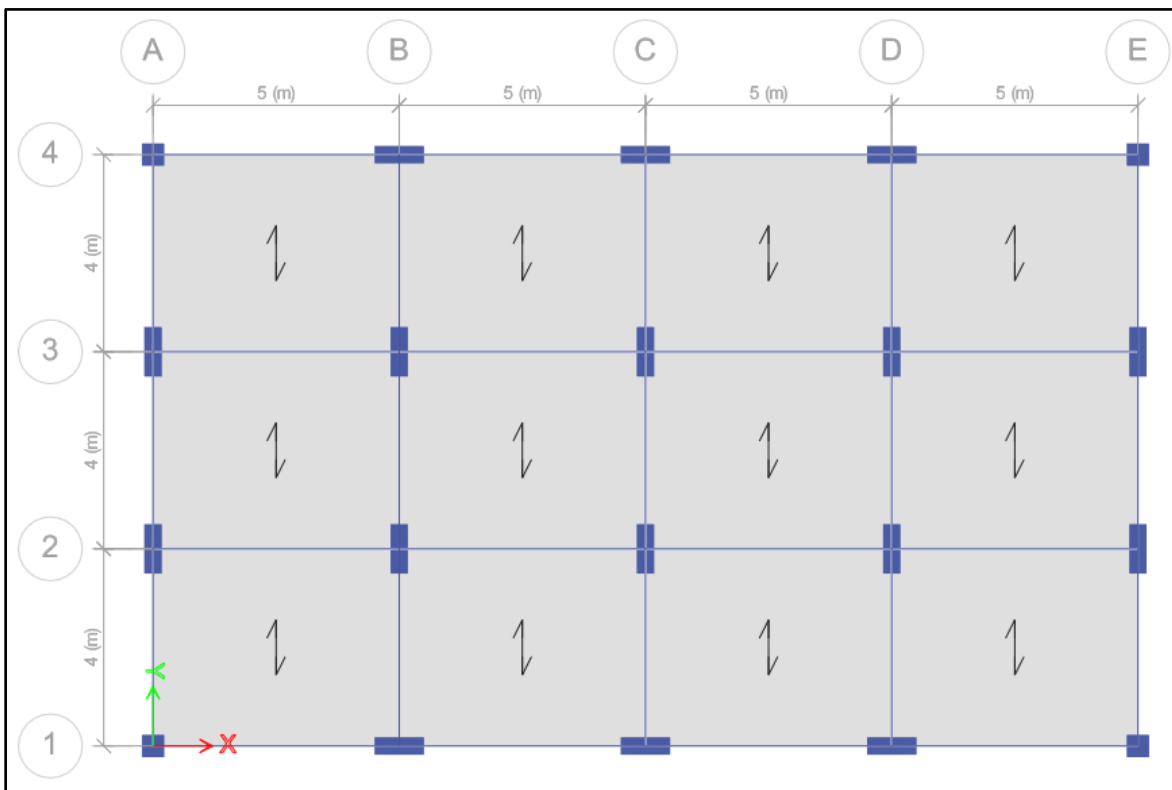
Planta Típica de la estructura idealizada. Fuente: Software Etabs v21
